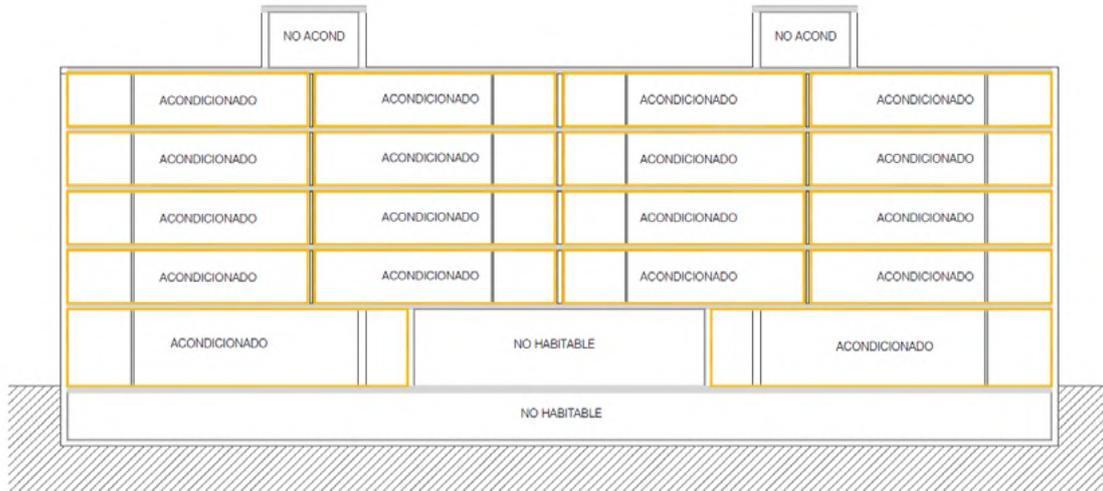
Plano planta de la vivienda objeto de estudio, mostrando los distintos cerramientos
